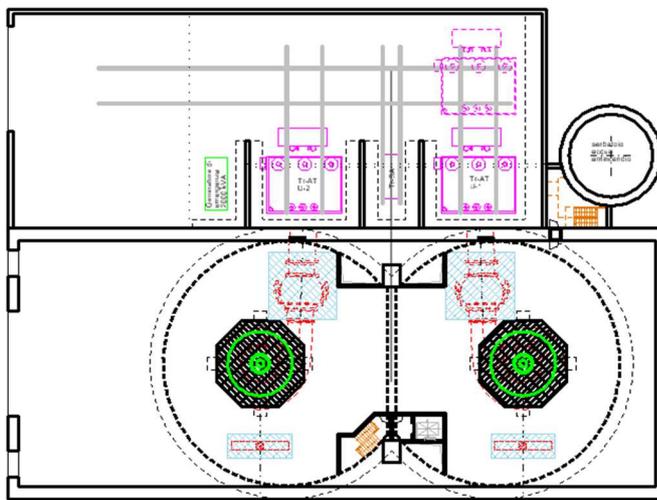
Pianta del piano -263,30 (estratto Tav. PD-EP.18.2).
